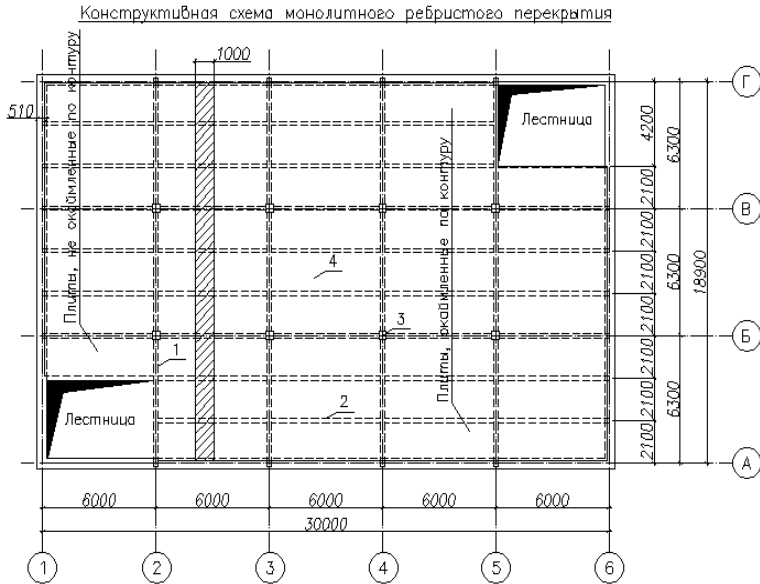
Конструктивная схема монолитного ребристого перекрытия:
